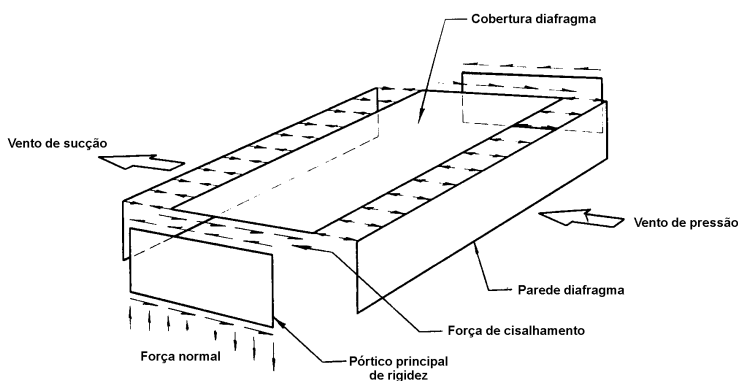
Ação diafragma (Fonte: Canadian Wood Construction, 1986)
